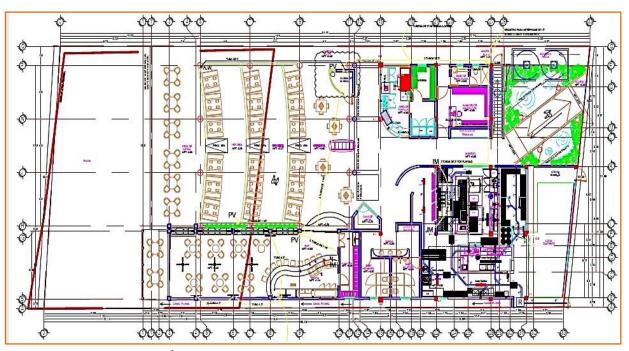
Área de la Superficie de desplante del proyecto.
